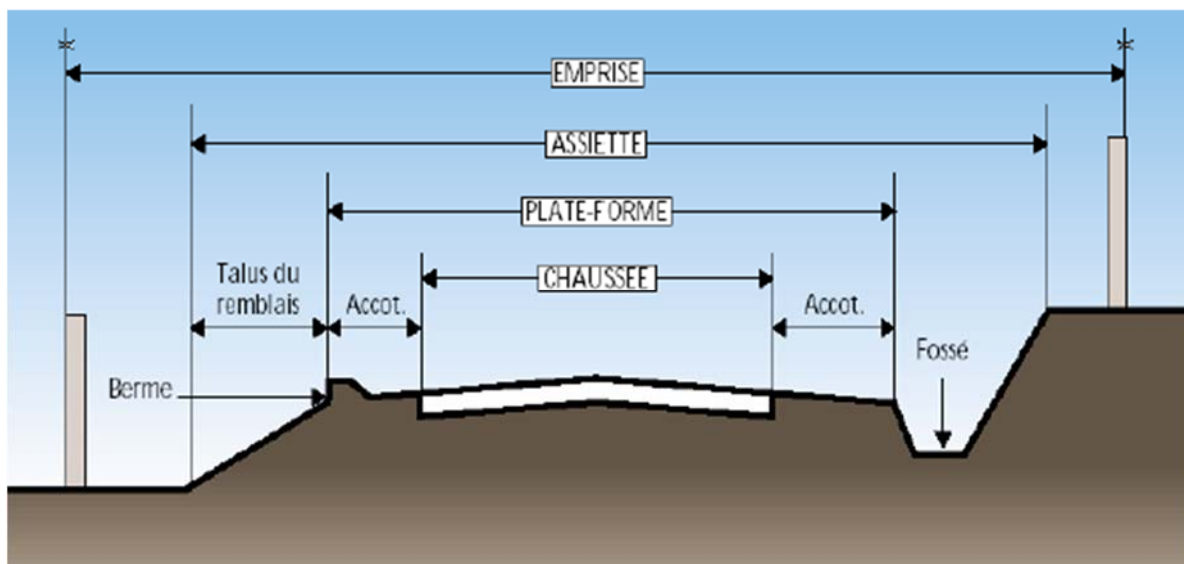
Profil en travers d'une chaussée bidirectionnelle [27]
